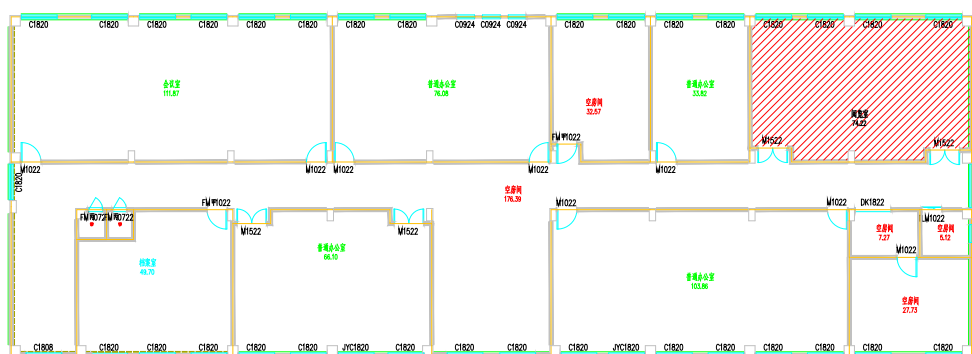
受建筑内设备噪声影响的典型房间楼层平面图
